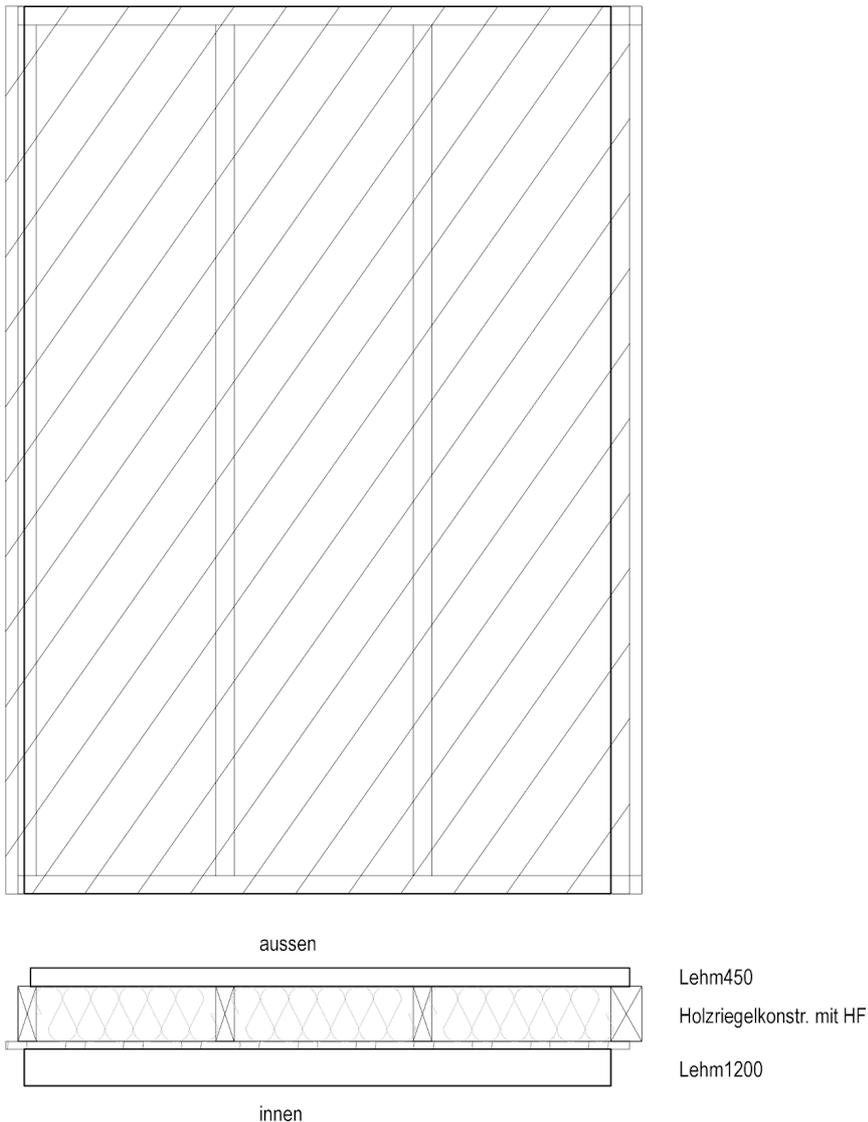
Einzelmodul in der Ansicht oben und im Grundriss unten.
